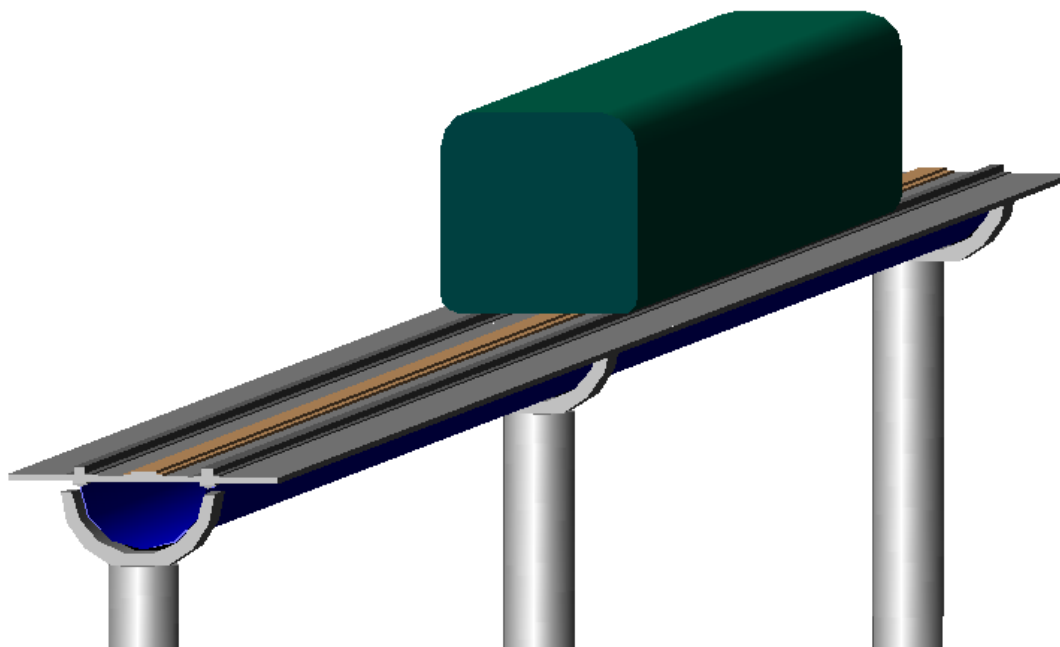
Vista tridimensional, 2ª Opção: vigas em seção semi-circular e pilares circulares vazados.
